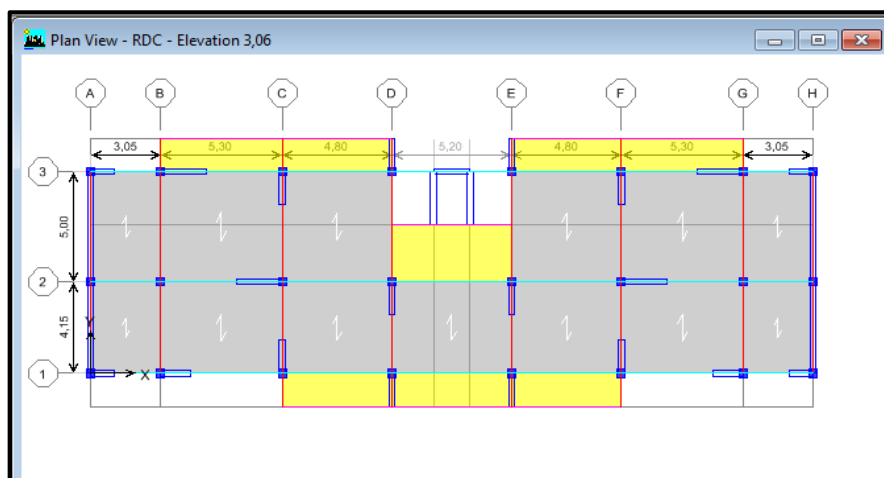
Vue en plan des éléments structuraux d'un étage.
